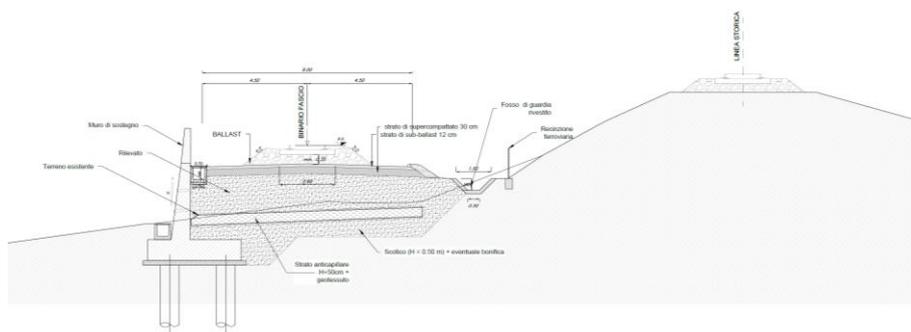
Binario Piazzale Porto, singolo binario con muro di sostegno
